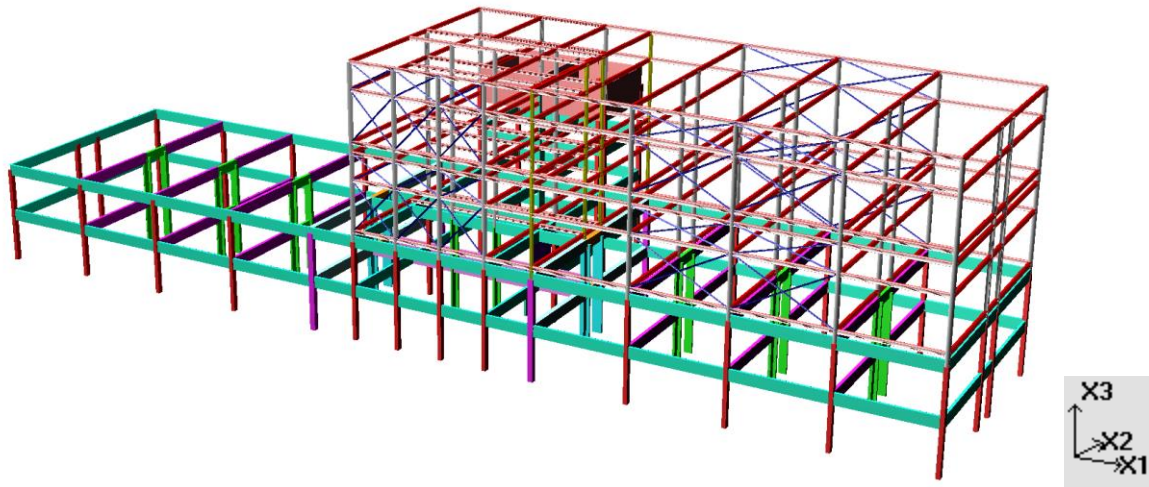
Estrutura com um pavimento extra – desenho renderizado
